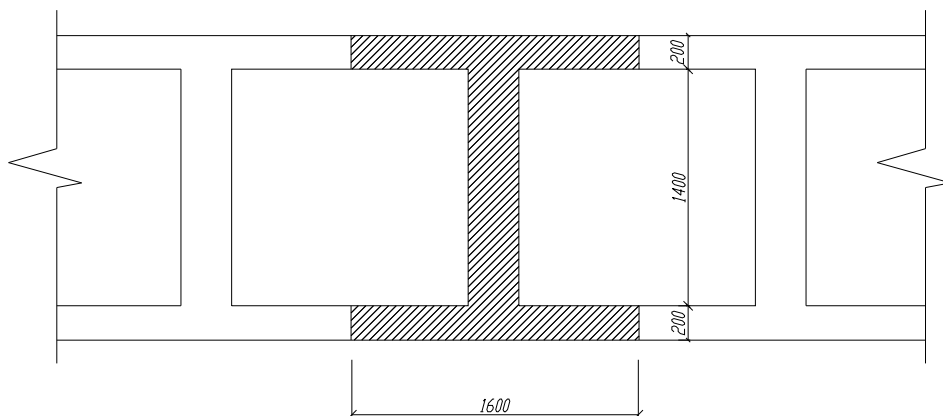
Поперечний переріз вирізаної ділянки фундамент
